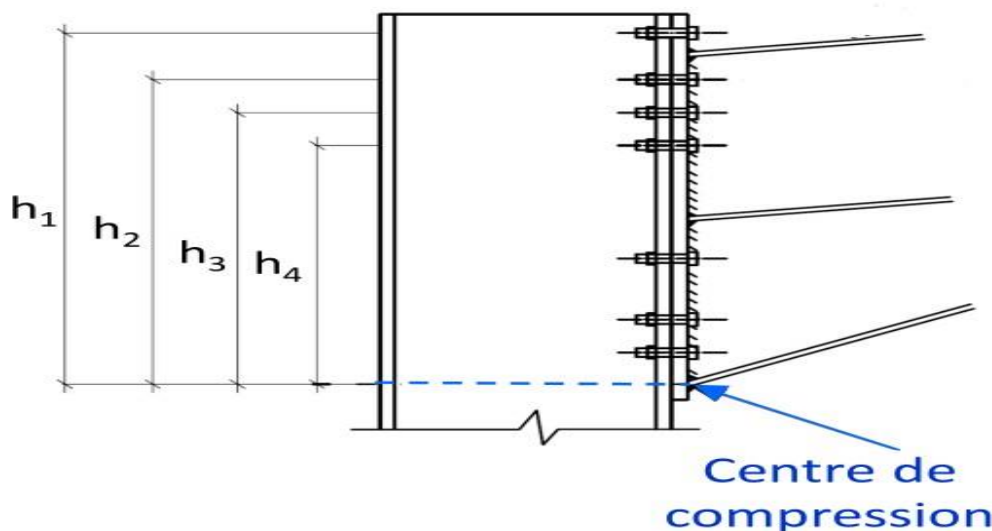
Centre de compression de la semelle de la poutre. [5]
